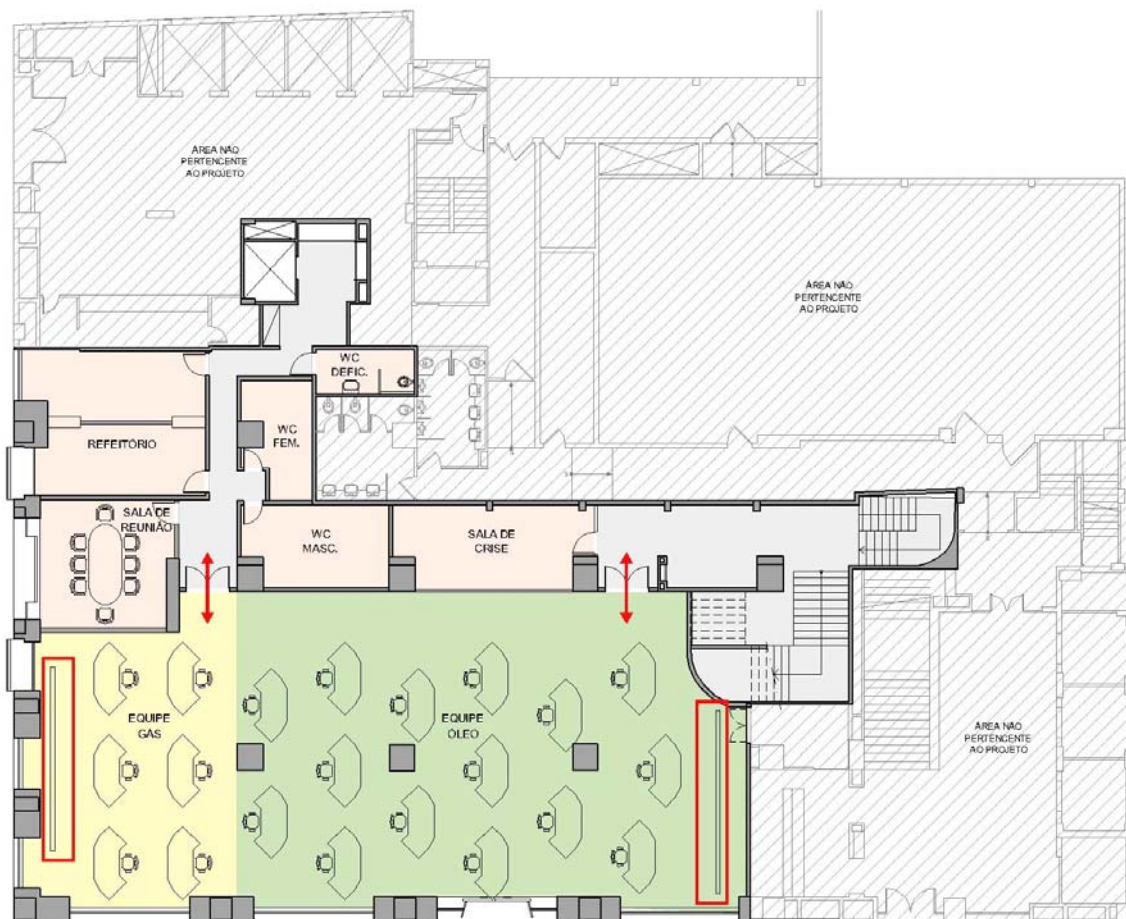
Planta baixa pavimento térreo: primeiro estudo de layout (trinta e um de maio)
